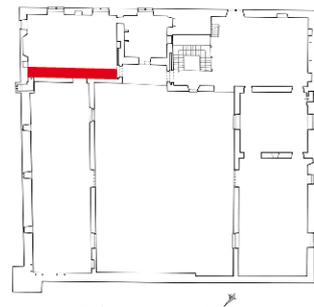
Mur nord (1203) de la pièce sud-est au rez-de-chaussée (PCE 13), croquis.
